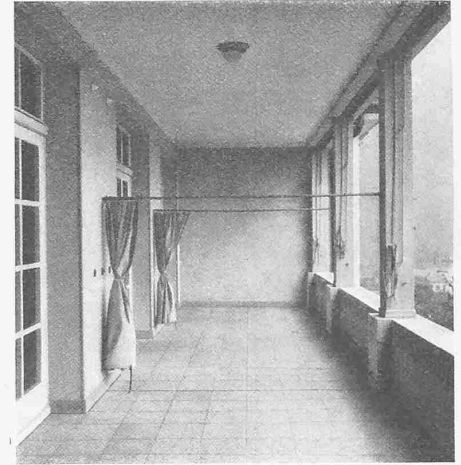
Liegehalle im Hauptbau-Obergeschoss.
